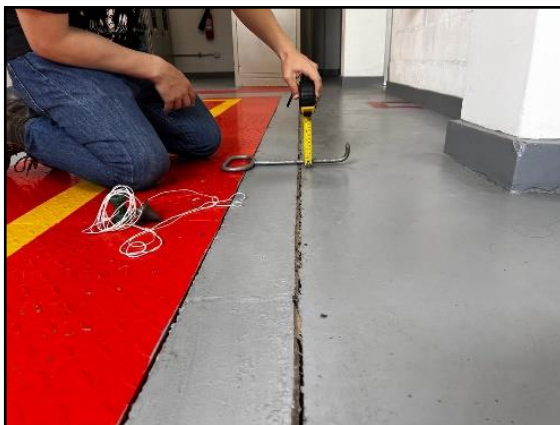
Fisuras en dilataciones de losa de contrapiso
